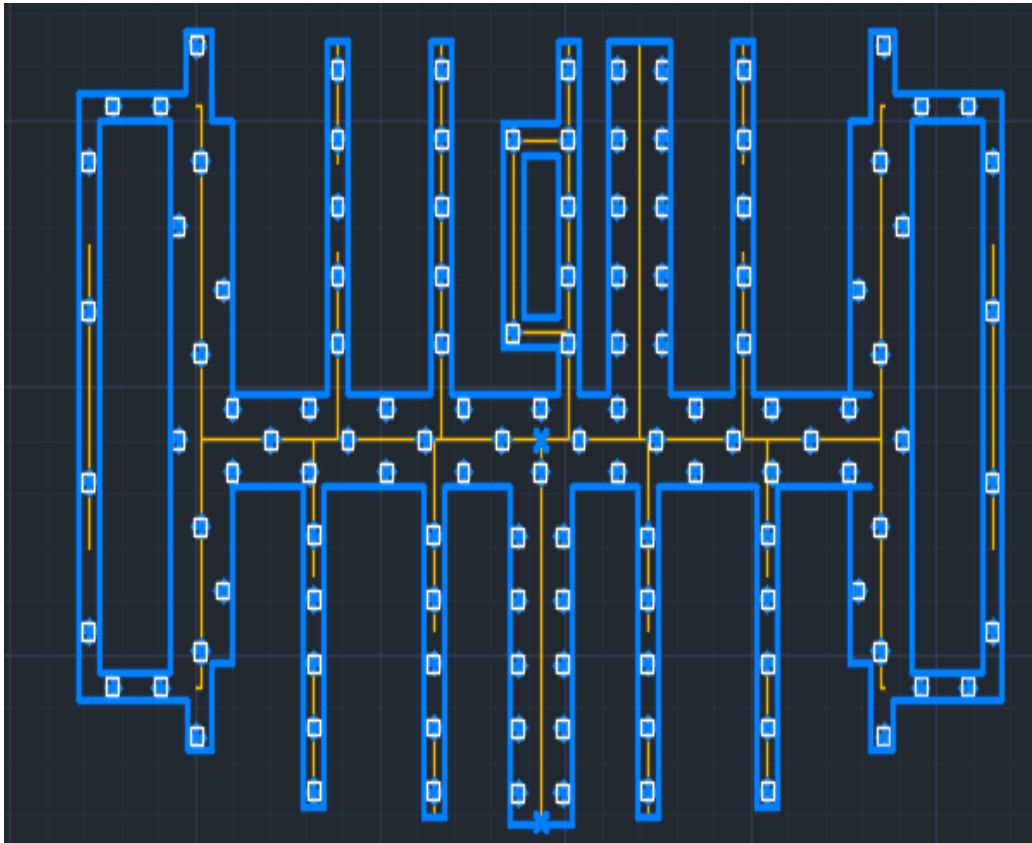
Розрахункова схема фундаменту
